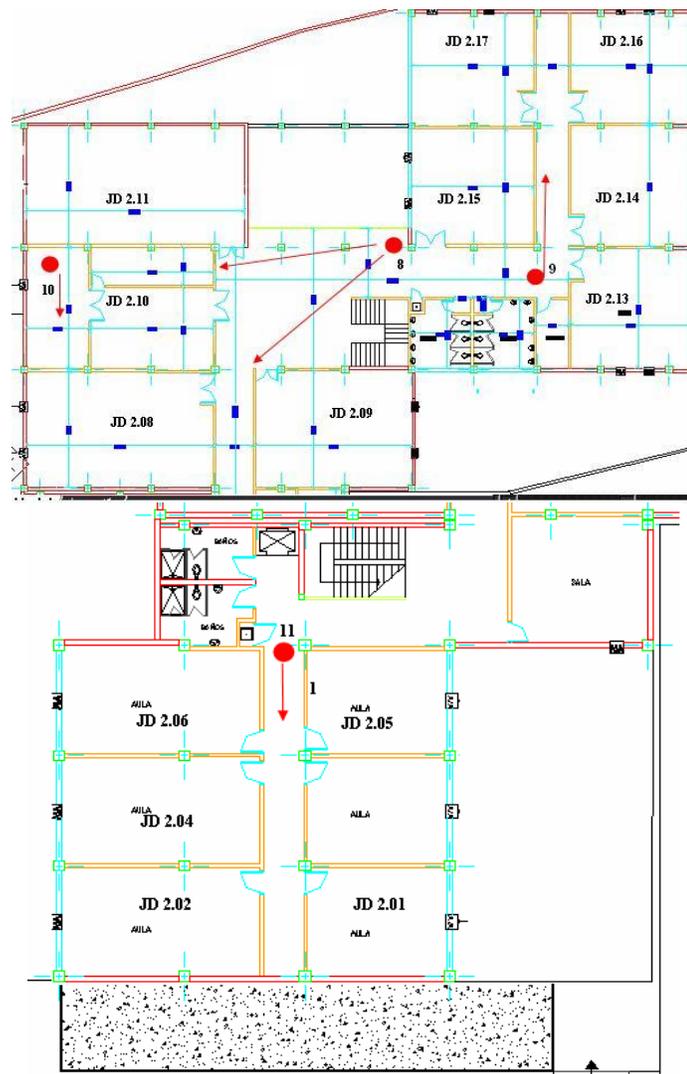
Ubicación de cámaras edificio Jan Deketh piso 2
